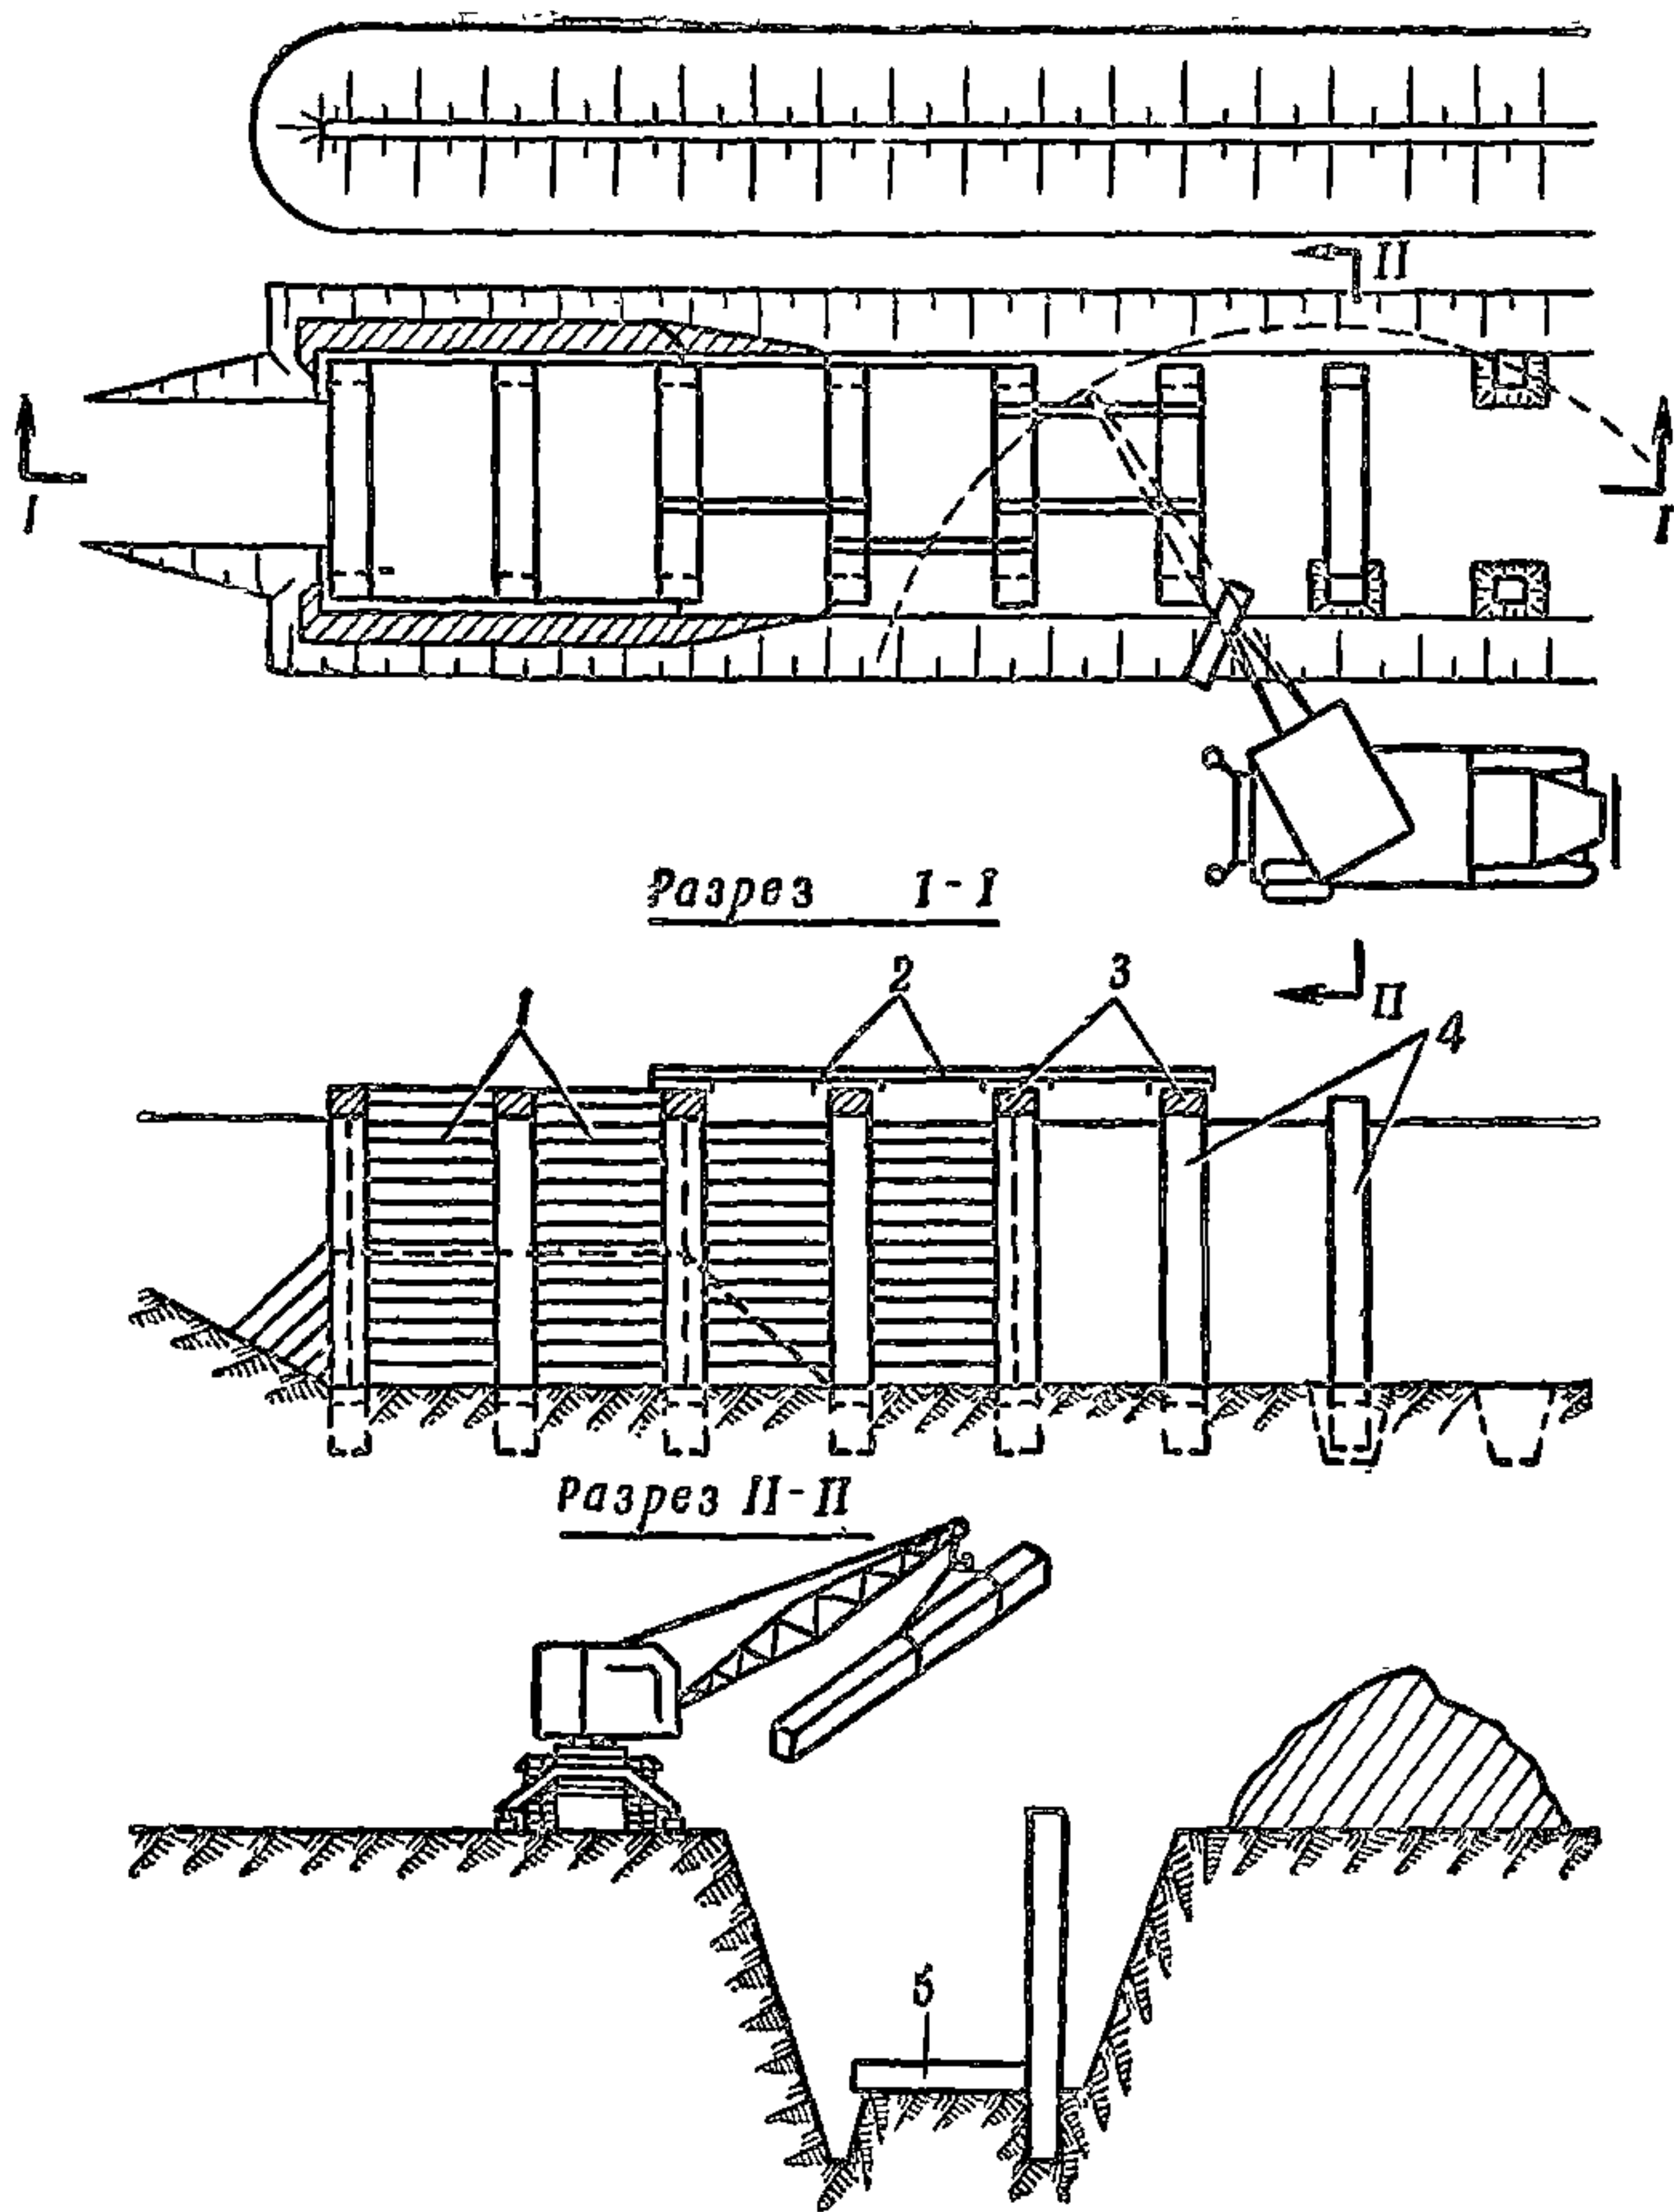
Схема производства работ по возведению остова из железобетонных рам с забиркой стен из дощатых щитов:
